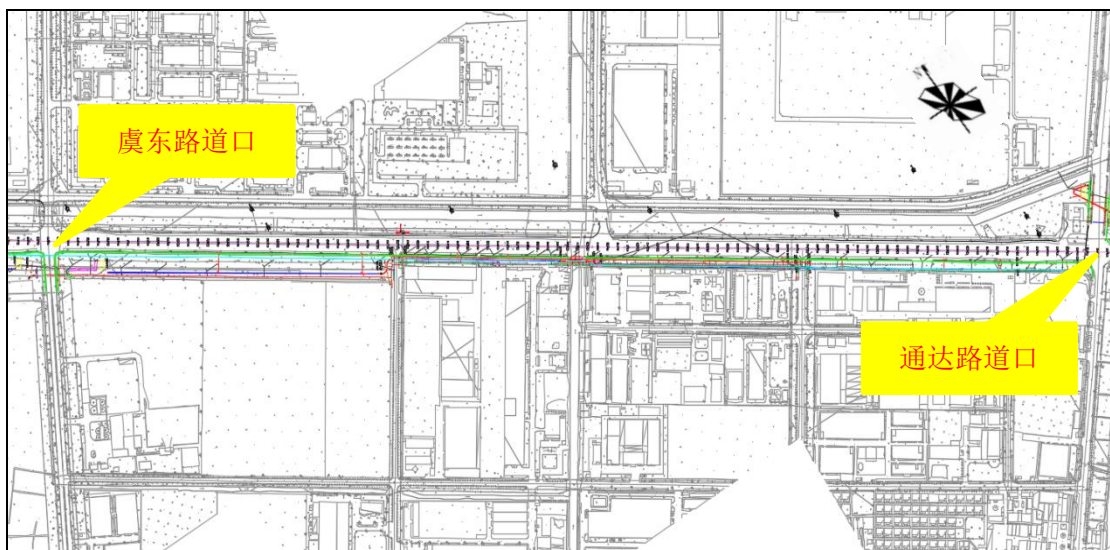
工程总平面布置图二（虞东路道口~通达路道口）
